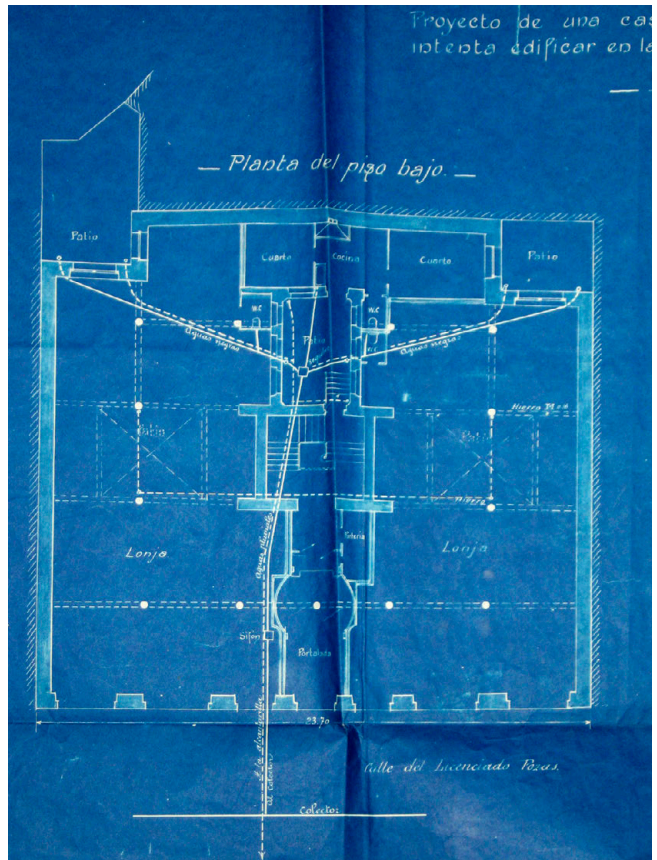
Plano de la planta baja de la casa de Francisco Usobiaga. Maestro de obras José Bilbao Lopategui. 1902. Calle Licenciado Poza nº 2. Bilbao. (AHFB, Municipal, Bilbao, 5, 222, Exp. 9)
